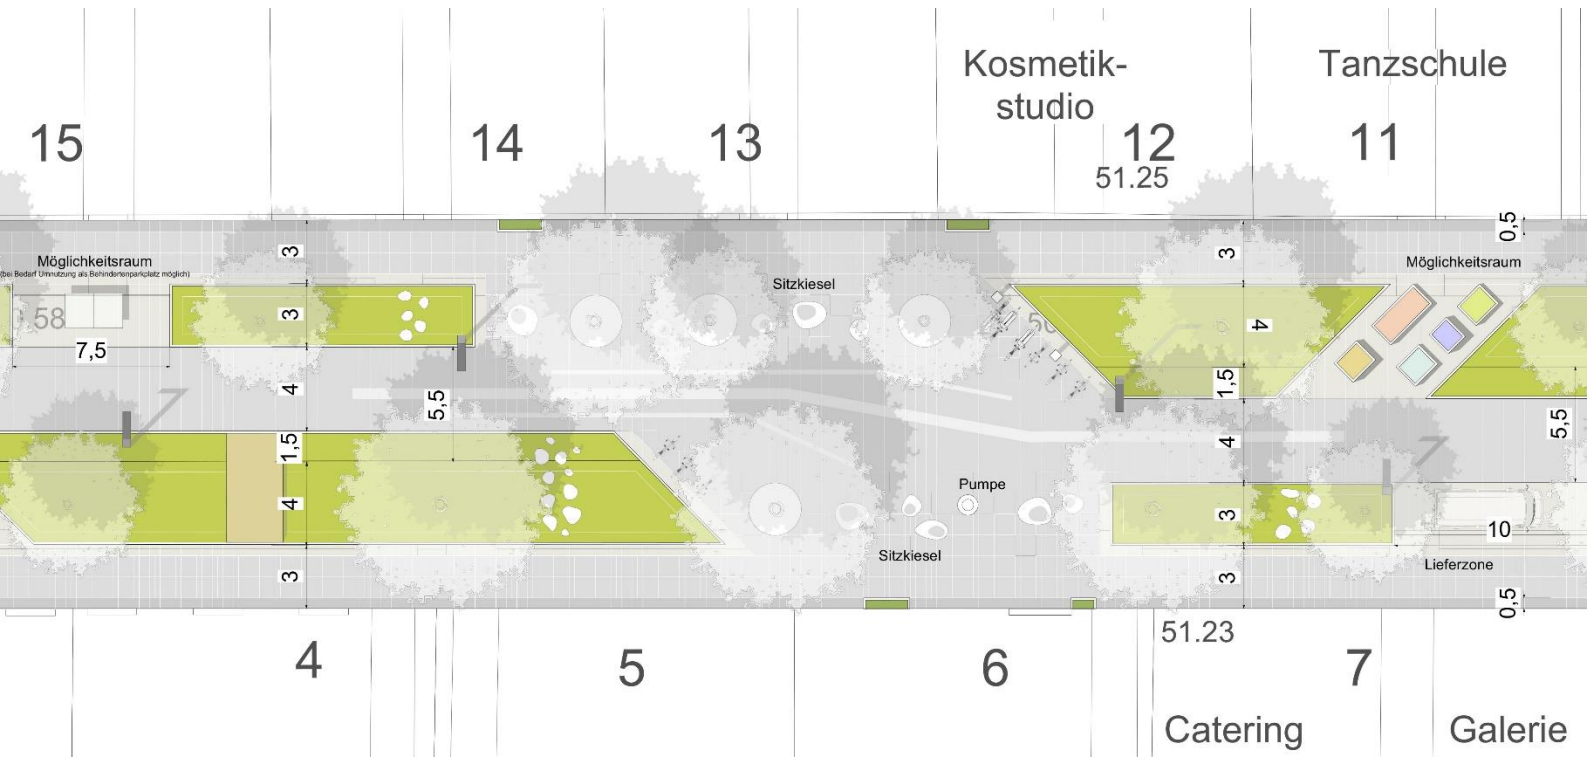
Detailausschnitt Planungskonzept Vorzugsvariante Klimastraße
